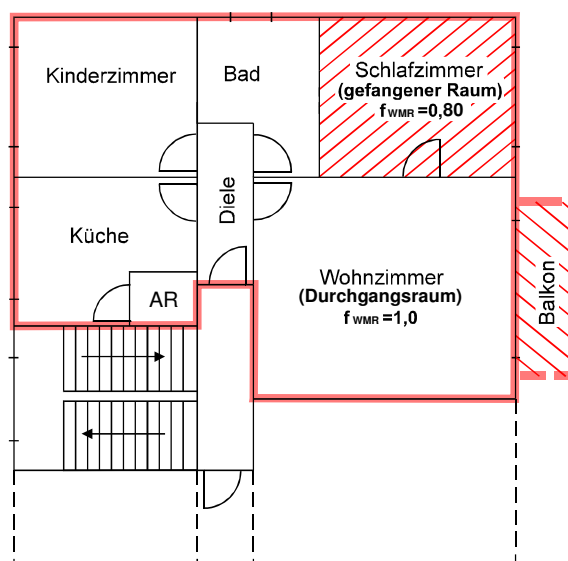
Wohnungsgrundriss mit Durchgangsraum als Hauptraum
